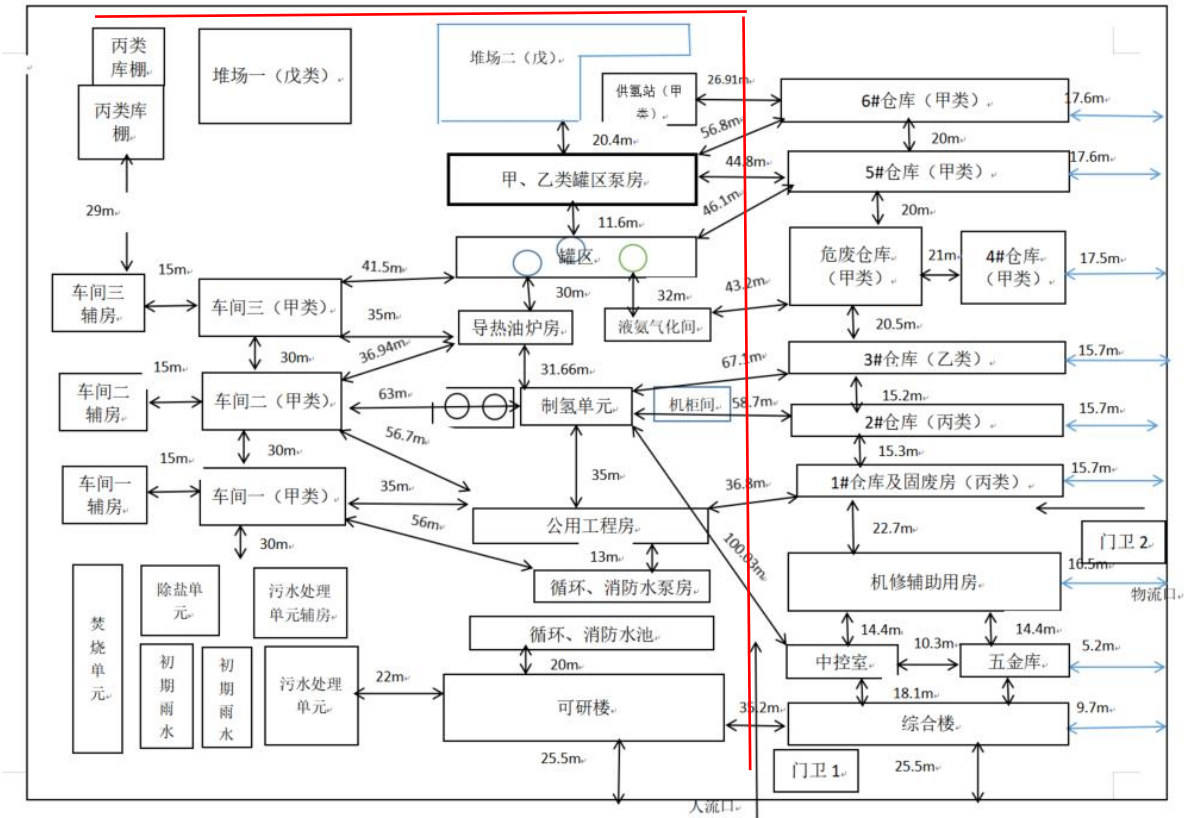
企业平面布置示意图（红色线条为公司运输道路）
